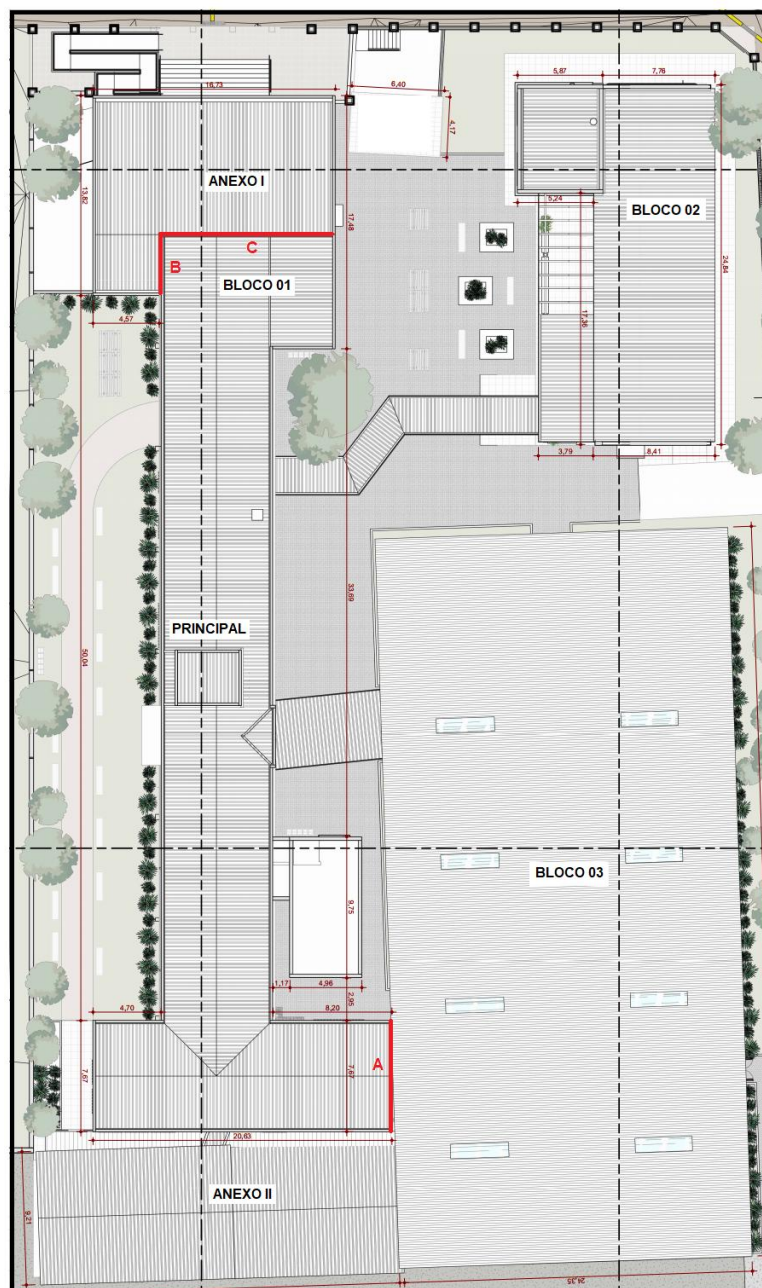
Planta Baixa (Blocos 01, 02 e 03)
